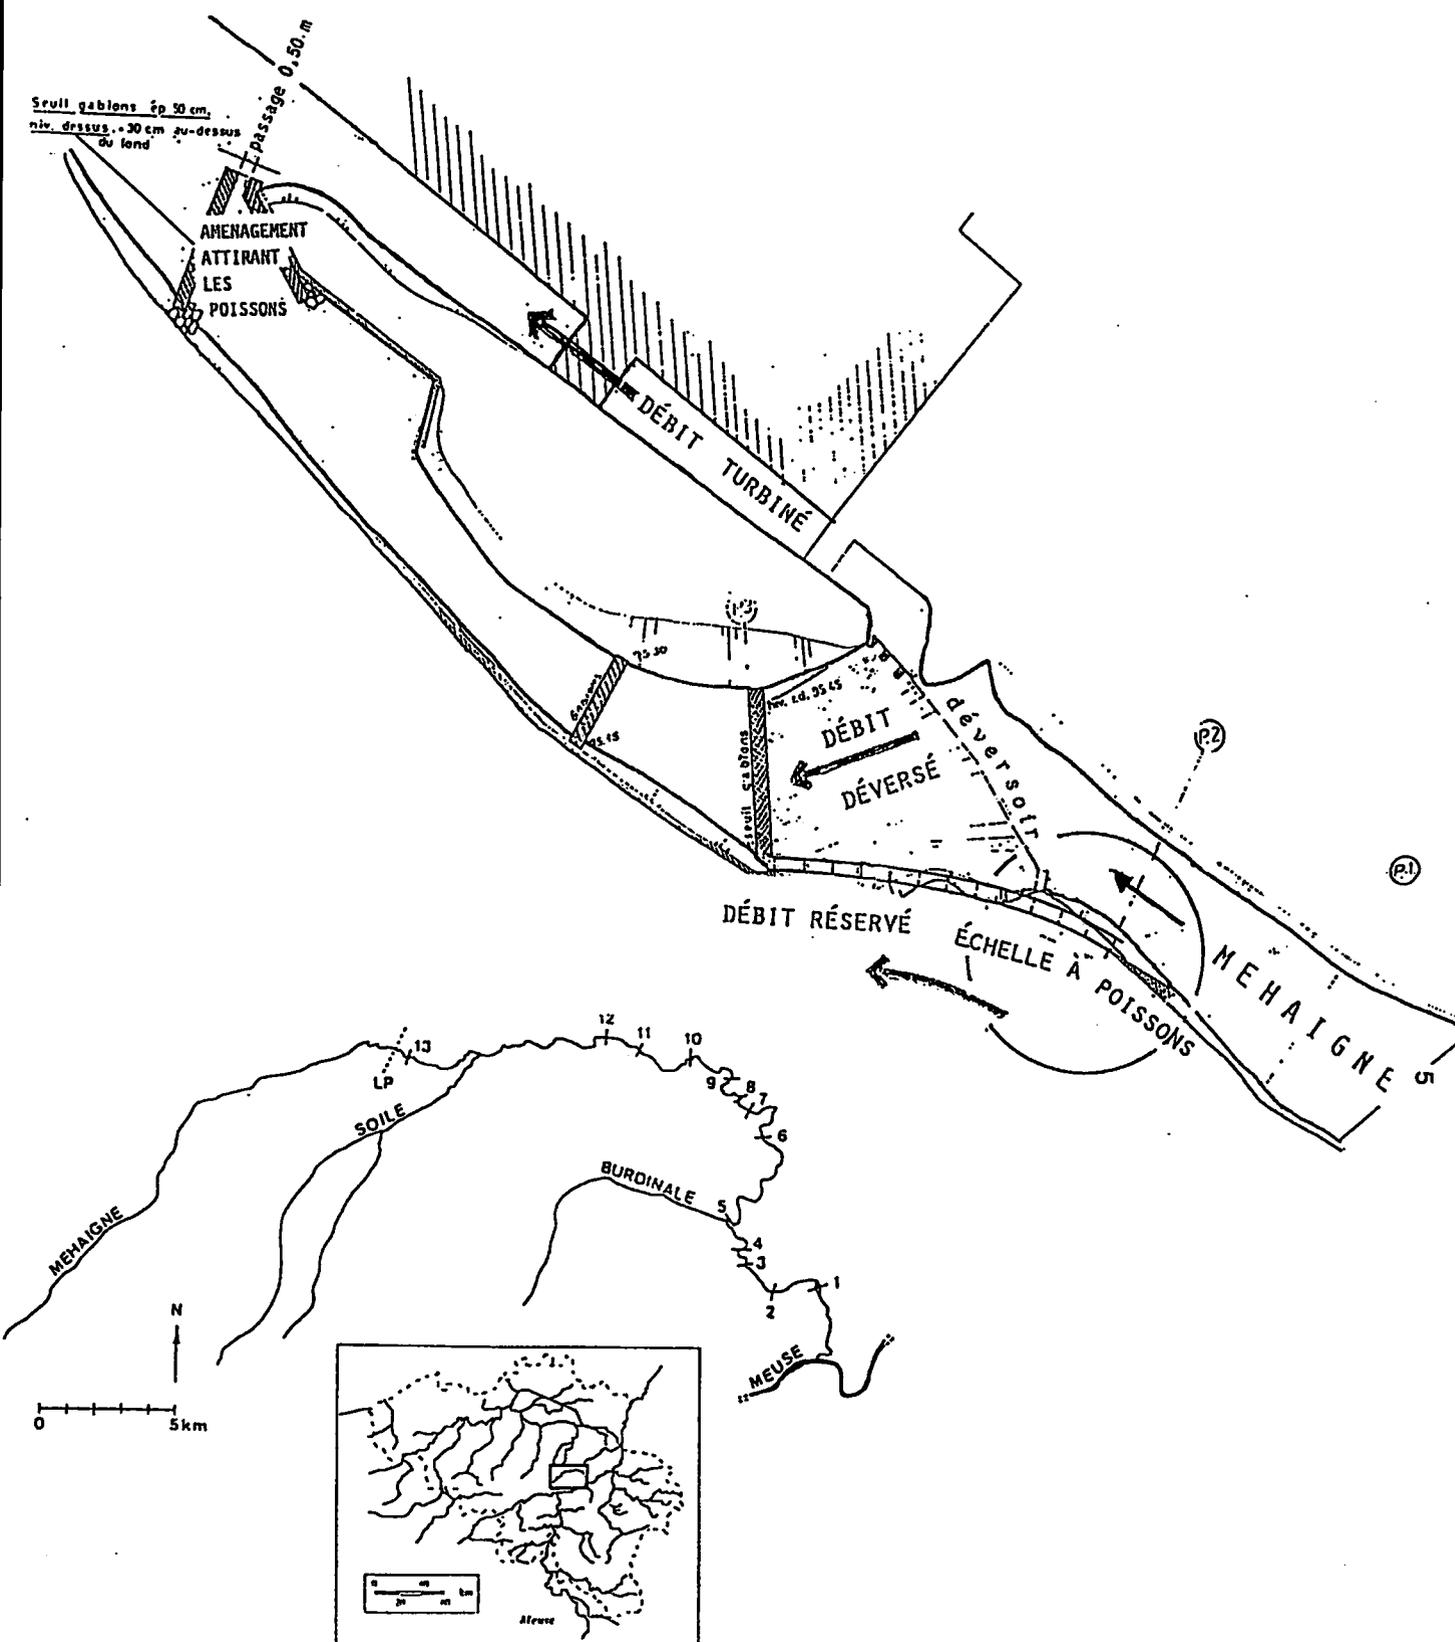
/2. Plan de situation (Van Damme, 1988) de l'échelle à poissons du barrage de Moha sur la Méhaigne indiquée par le chiffre 2 sur la carte.
